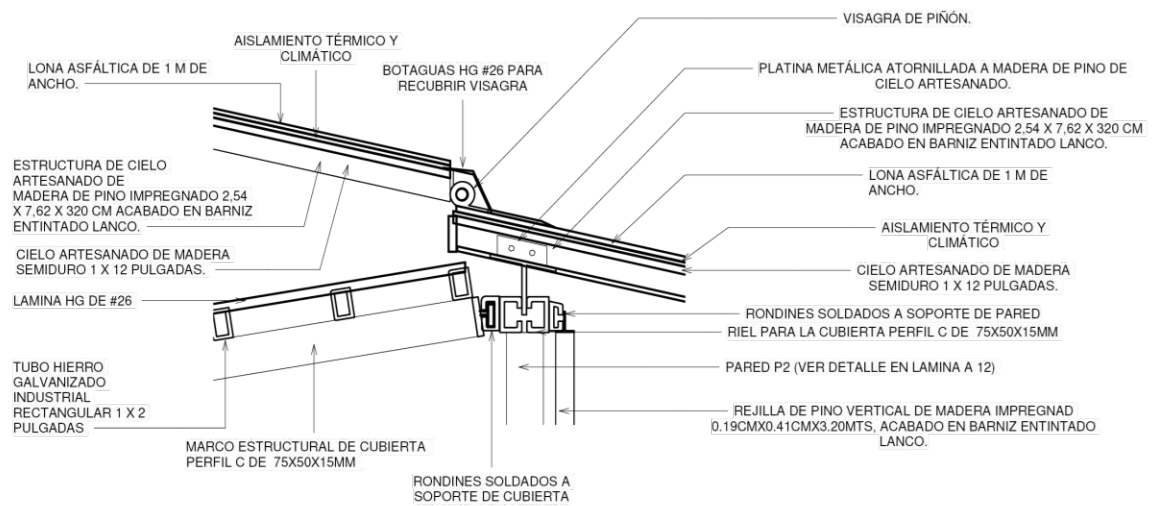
Detalles de Cubiertas. Elaboración Propia
